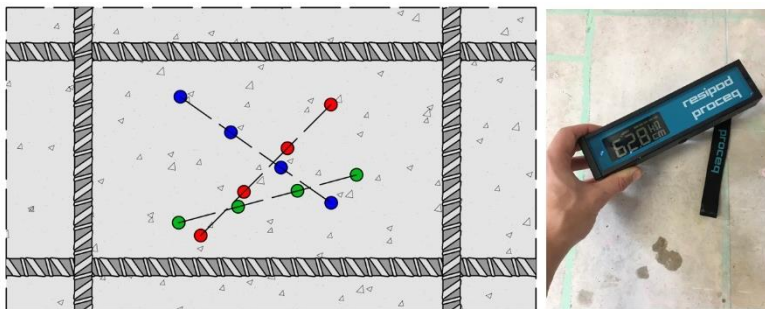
33. Replanteo de las medidas con el sistema de las 4 puntas y medida sobre losa de hormigón armado. Elaboración propia.
